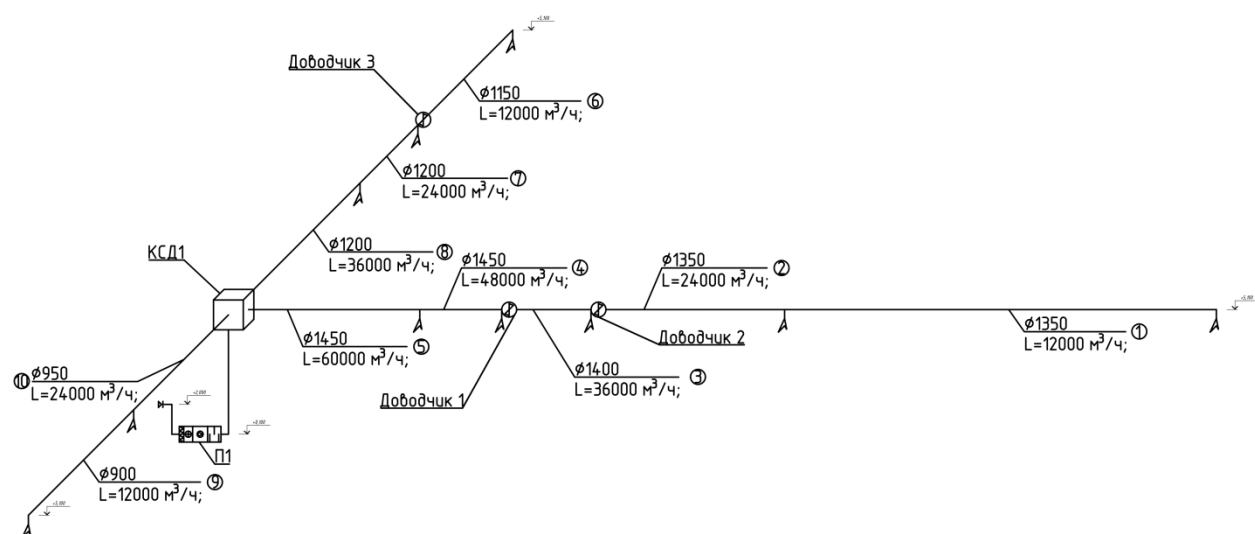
Расчетная схема приточной системы вентиляции с вентиляторами-доводчиками
